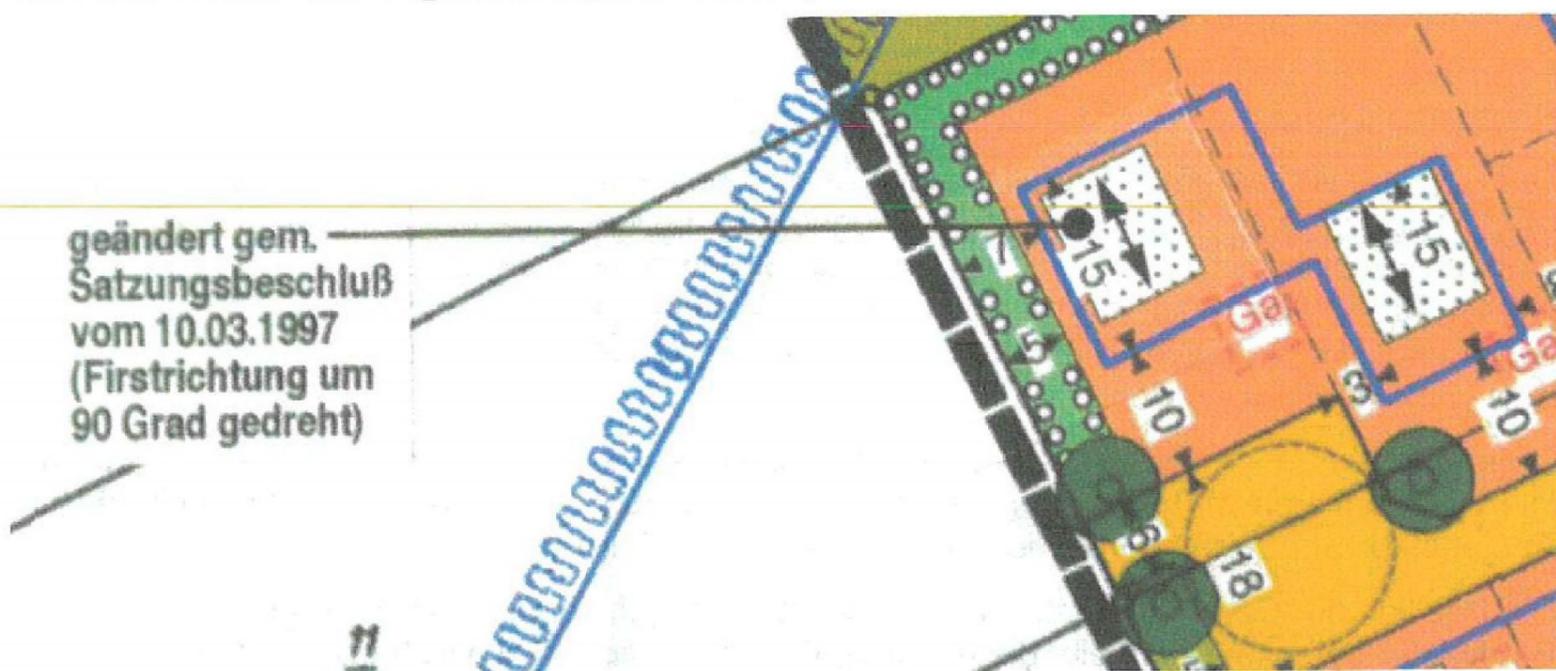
Änderung der Firstrichtung gemäß Satzungsbeschluss vom 10.03.1997.
